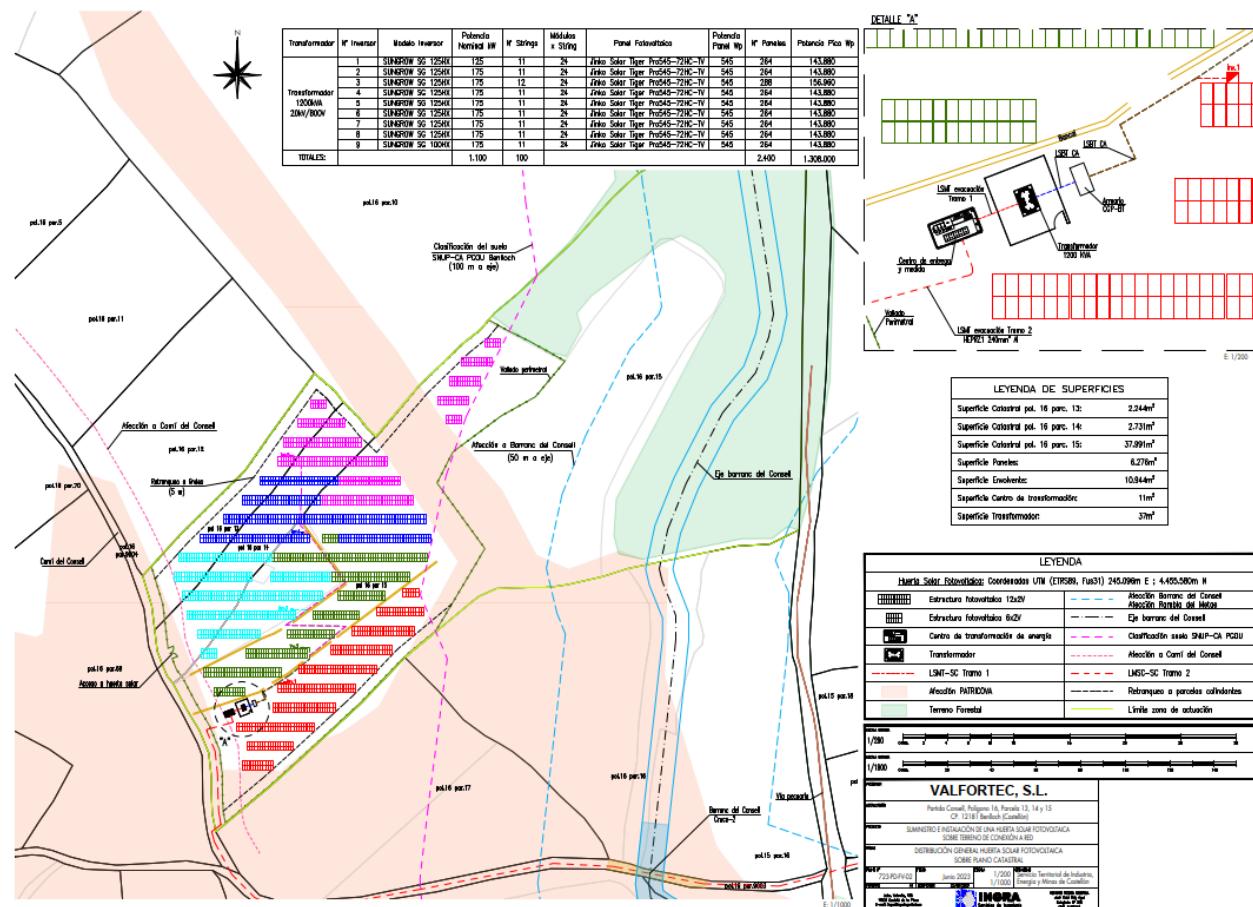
Extracto del plano de distribución de planta de la propuesta corregida
